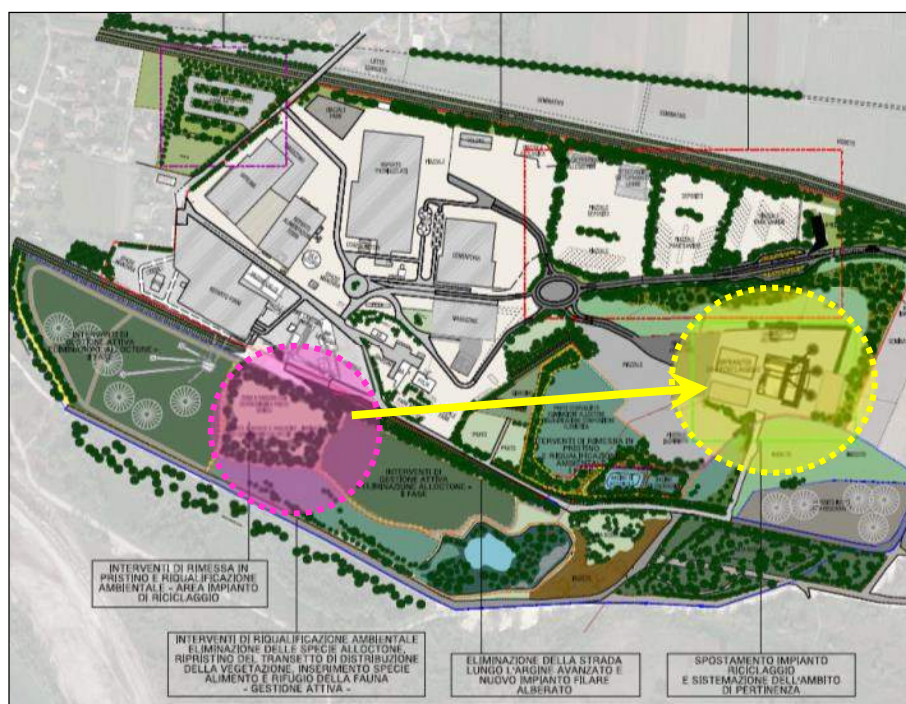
Estratto della Planimetria generale degli interventi previsti dal Masterplan con indicazione della ricollocazione dell'impianto di recupero (cerchio giallo).
